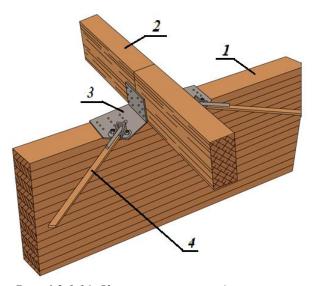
Крепление связей с деревянными прогоном и тяжами из полосовой стали 1 - основная клееная конструкция (балка), 2 - разрезной прогон, служащий распоркой связевой решетки, 3 - стальная пластина на дюбелях или гвоздях, 4 - тяж-раскос связевой решетки из полосовой стали
